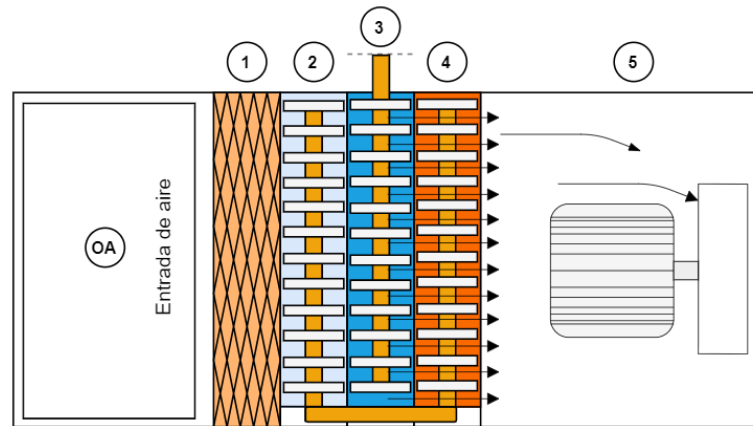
Vista en planta configuración: tubos de calor. Fuente: (Elaboración propia).
